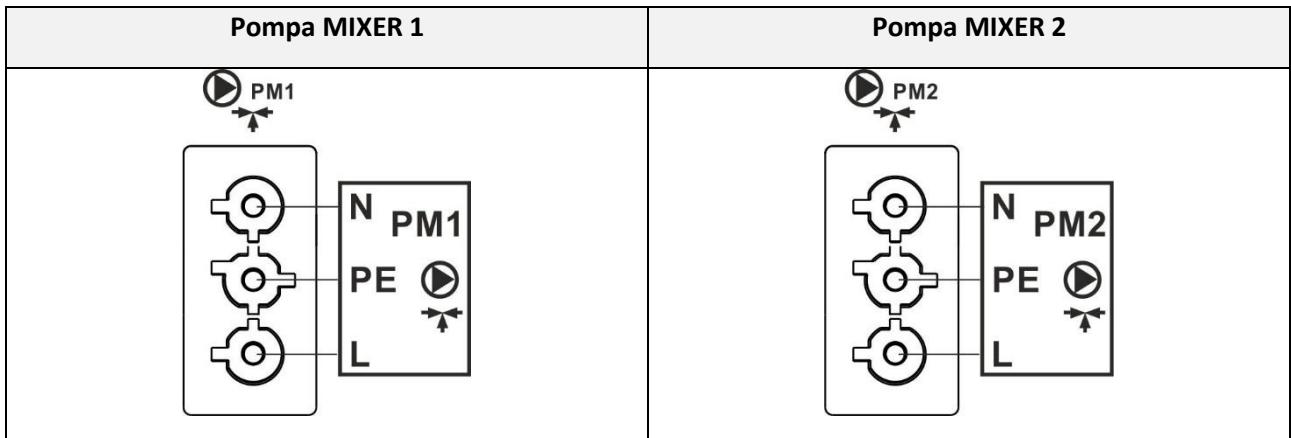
Schema elettrico del collegamento delle pompe MIXER
